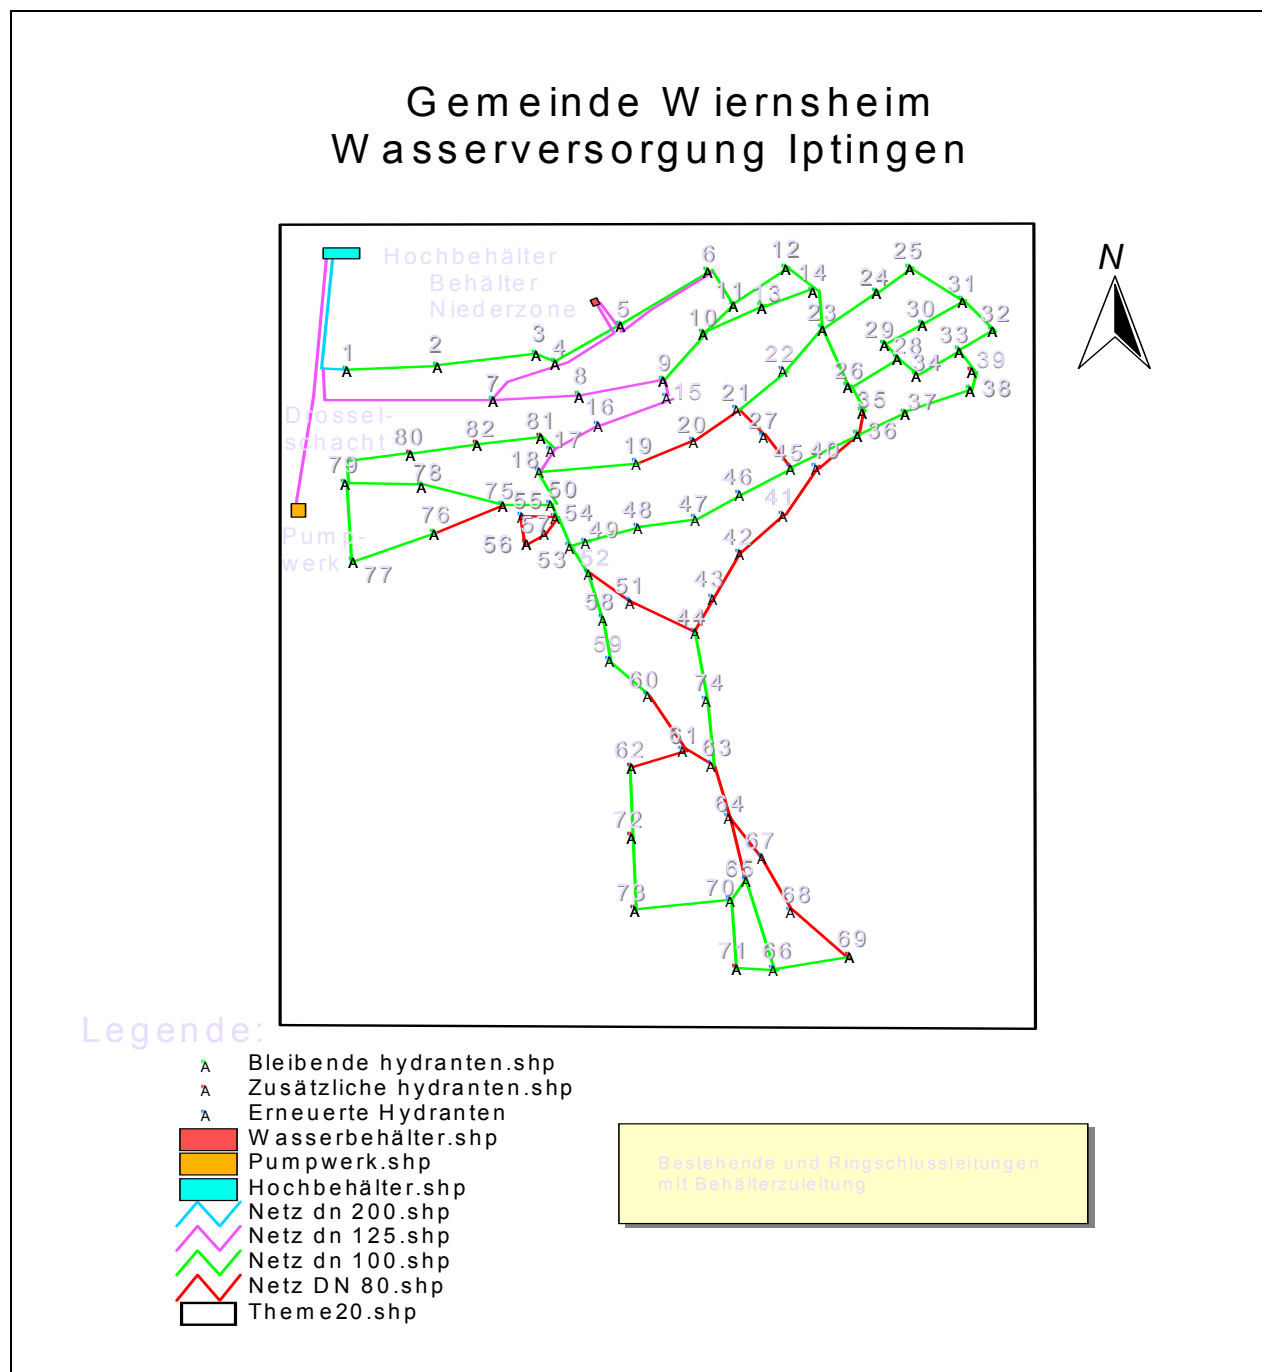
Netzplan mit Nennweiten der Rohre im Bestand und mit Ringschluss
